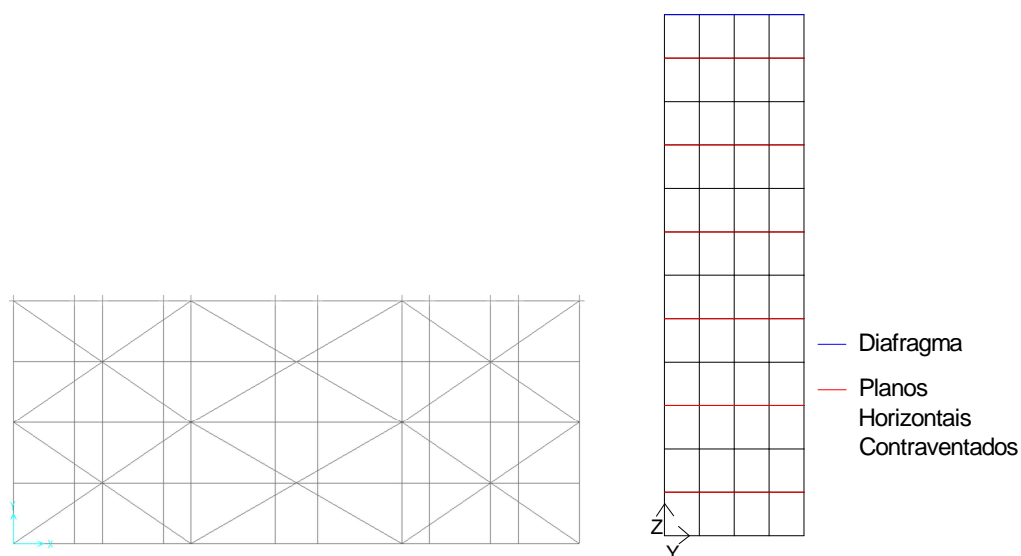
Configuração dos Planos de Contraventamento Horizontal Com Elementos de Contraventamento Grandes
